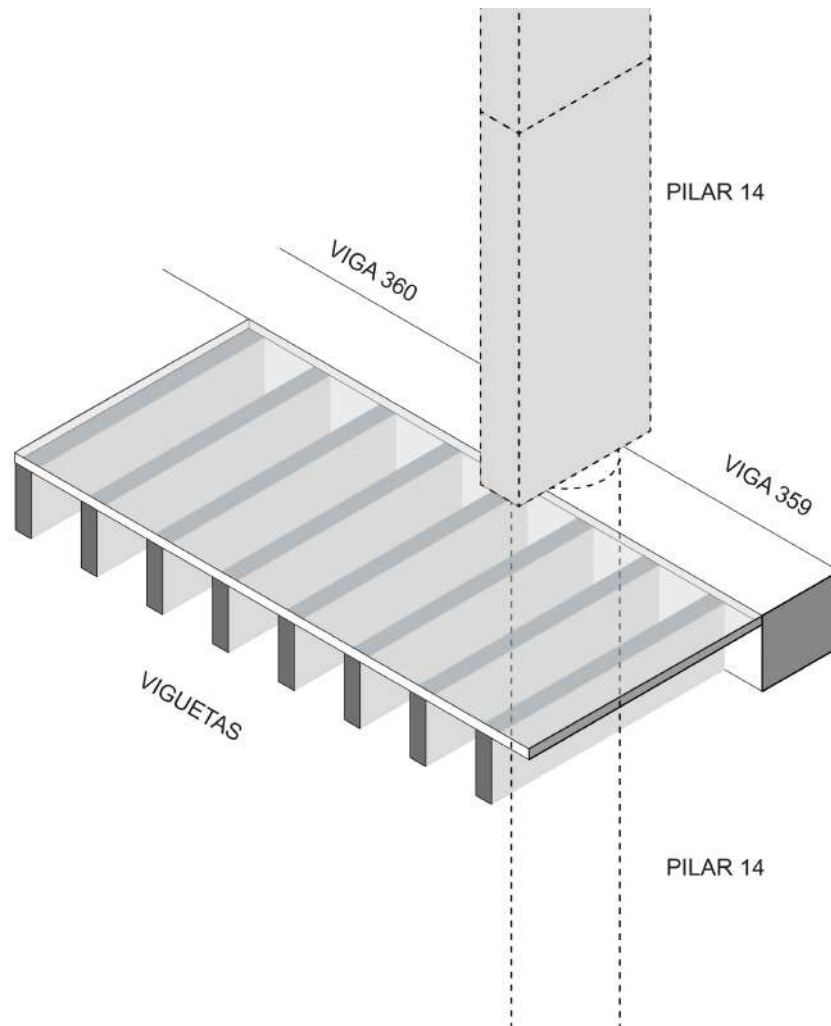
Modelado del punto de encuentro entre viga, losa y pilar 14 en los entresijos del BCLA.
